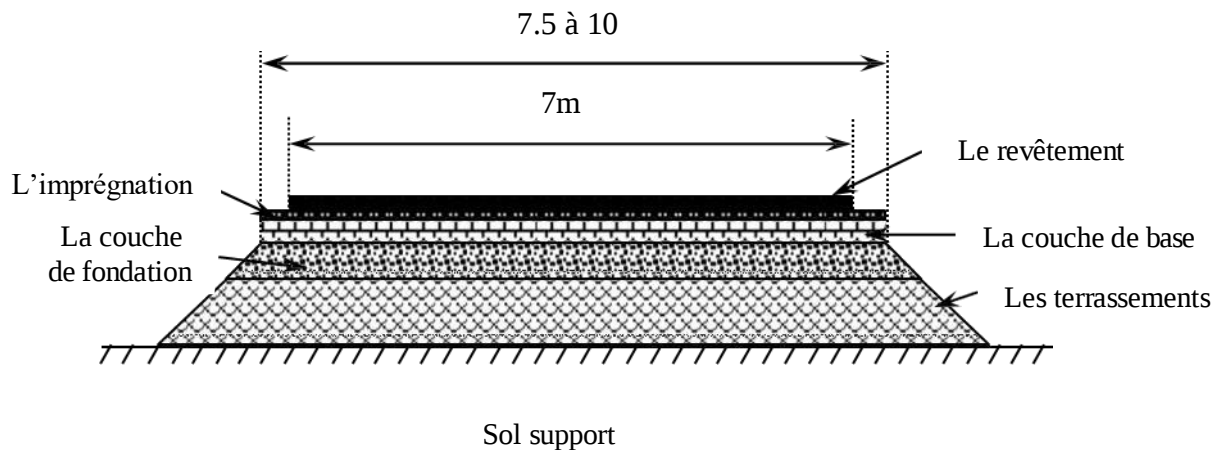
Coupe transversale type d'une chaussée saharienne (Morsli, 2007)
